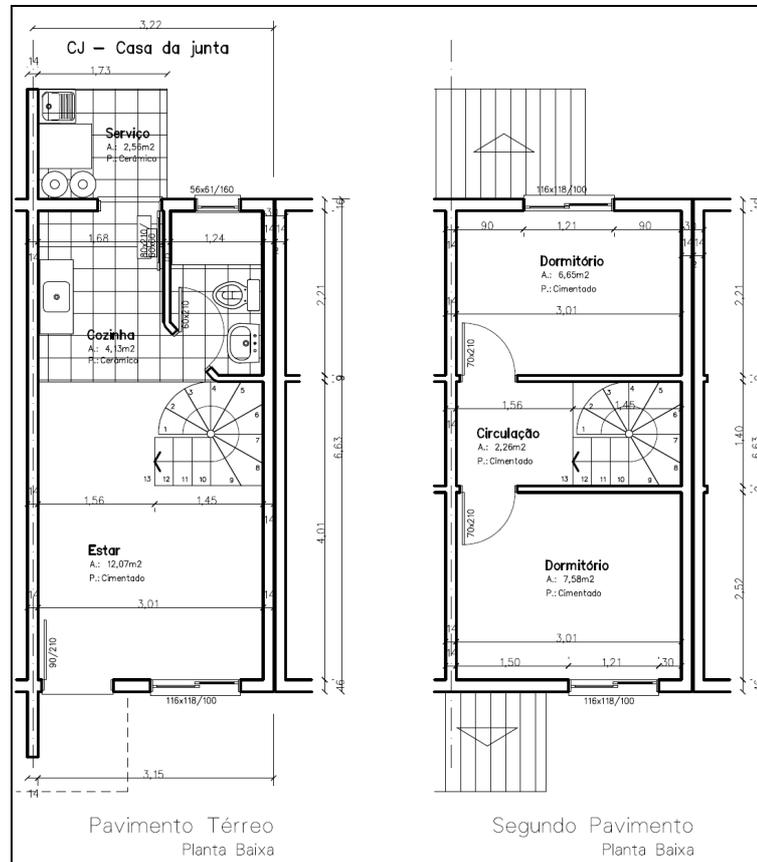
Plantas baixas casa 2 pavimentos – Condomínio Germano Arduino Toniolo – 44,79m²
